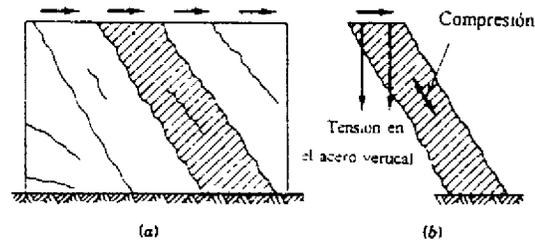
Puntal de compresión entre grietas para muros robustos
